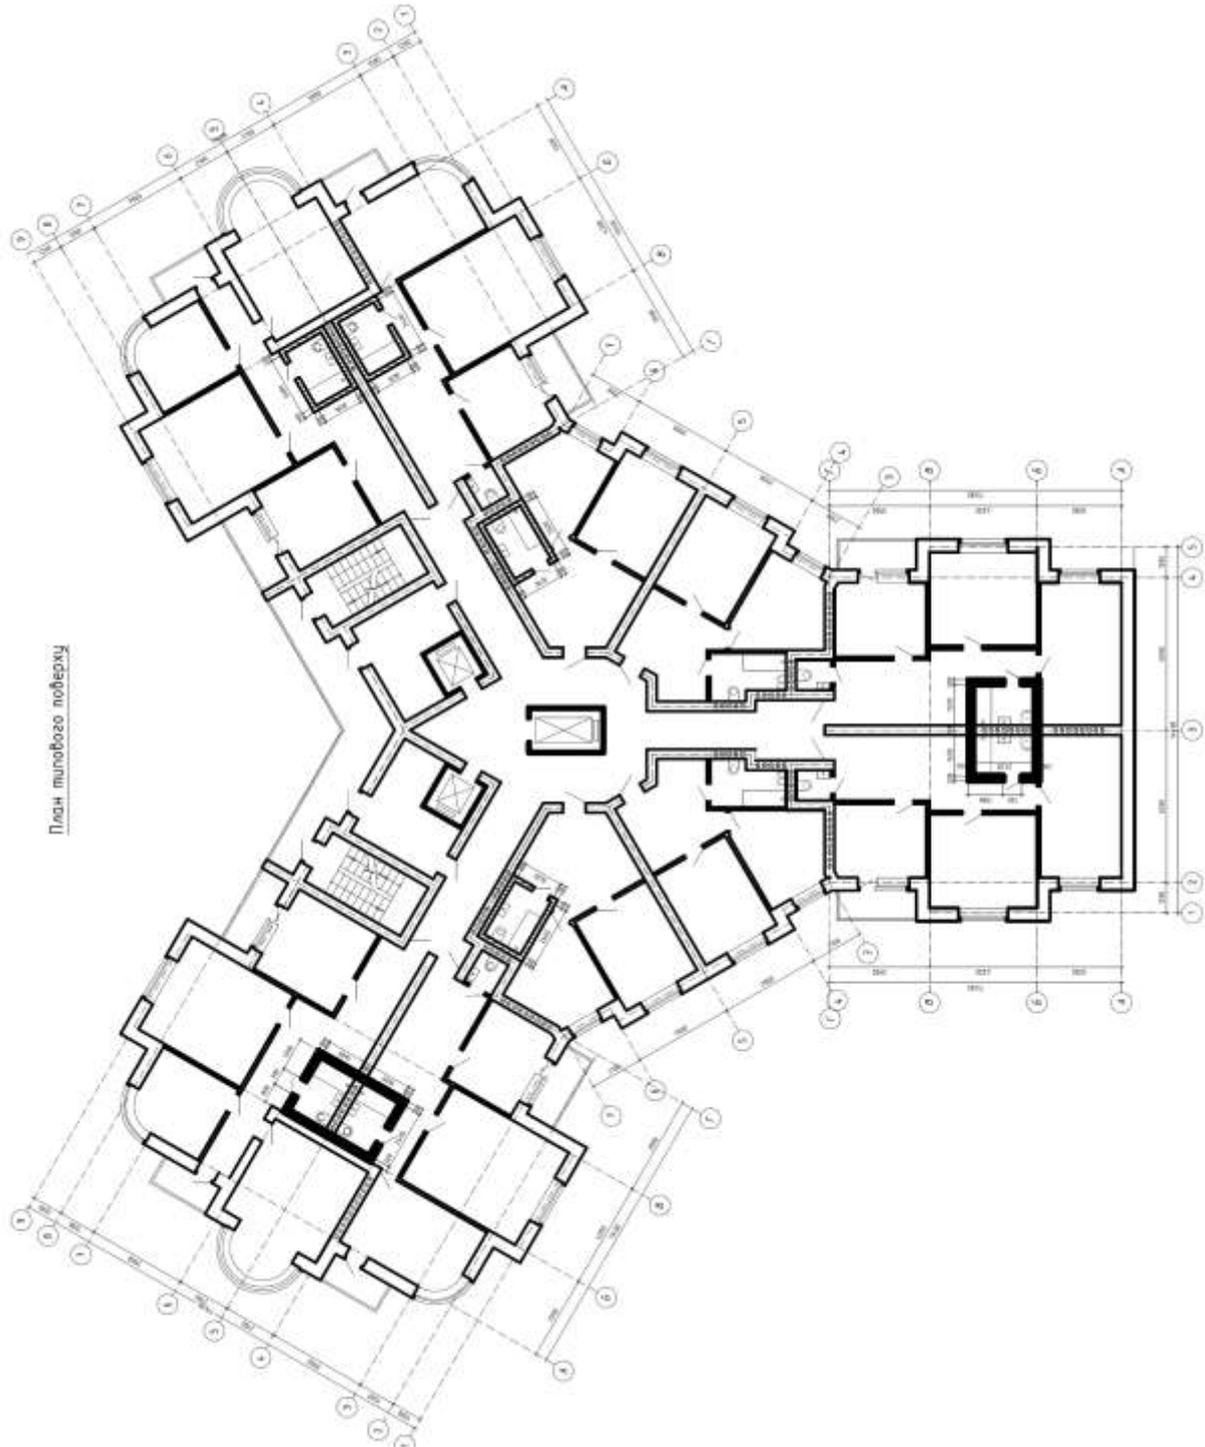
План типового поверху житлового багатоповерхового будинку з вбудованими захищеними приміщеннями
